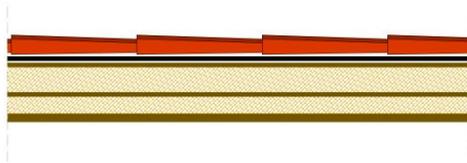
Cubierta inclinada aislada en su parte inferior. 2014. AutoCAD.
